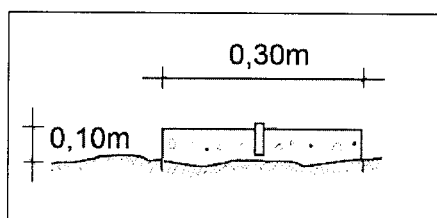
Monolito Hormigón fundado sobre roca, vista en elevación y sus dimensiones
